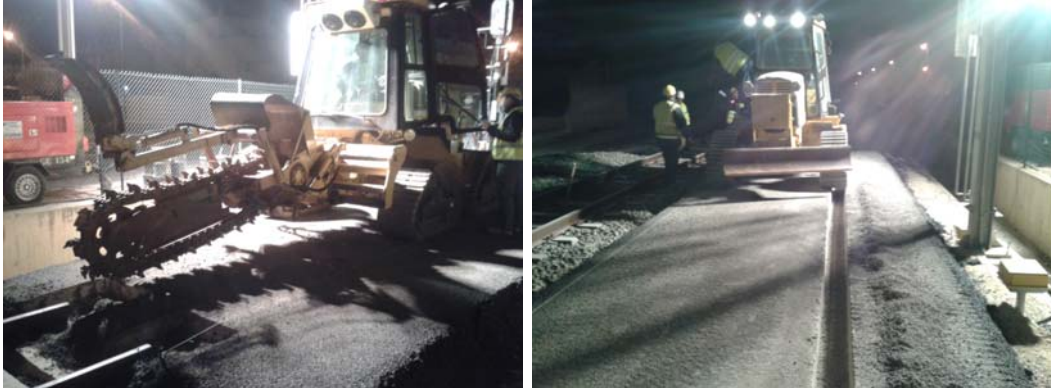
Rozado de la losa SMA20 con rozadora para la ejecución de los cajetines de embebido de los carriles Ph37N. Fuente: Elaboración propia
